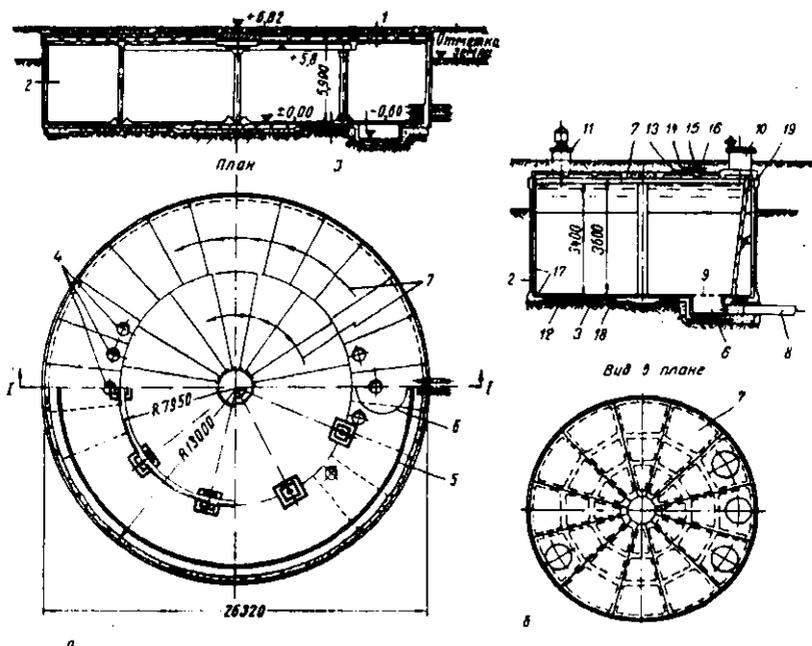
Монолитные цилиндрические железобетонные резервуары:
